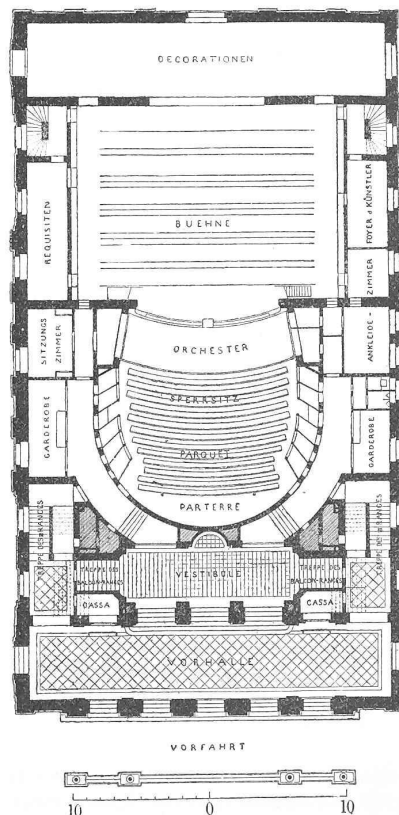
Grundriss des Parketts. — 1 : 500.
